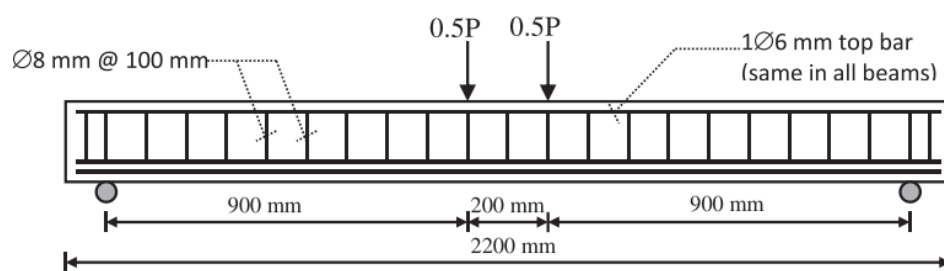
Esquema de carregamento das vigas ensaiadas
